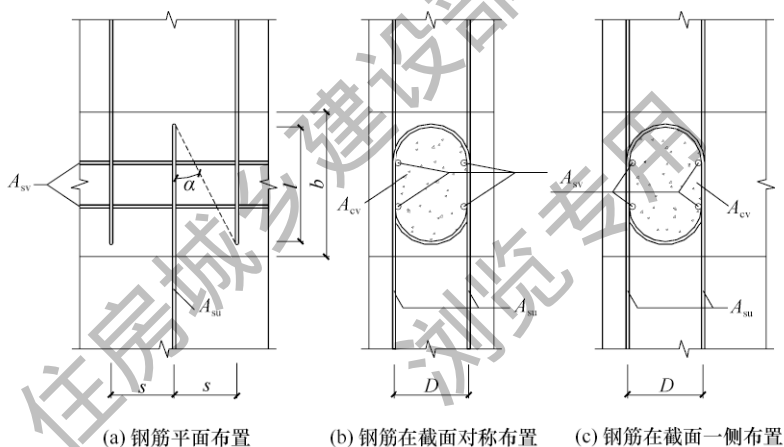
U 形钢筋交错布置现浇混凝土接缝的计算参数示意
